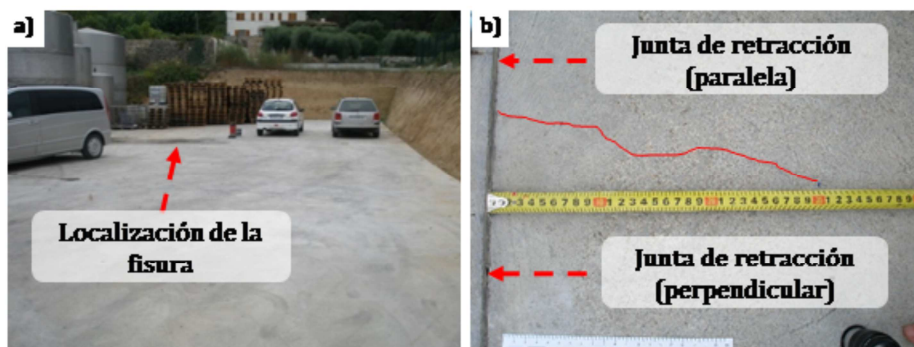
12 – a) localización de la fisura; b) geometría de la fisura y juntas cercanas
